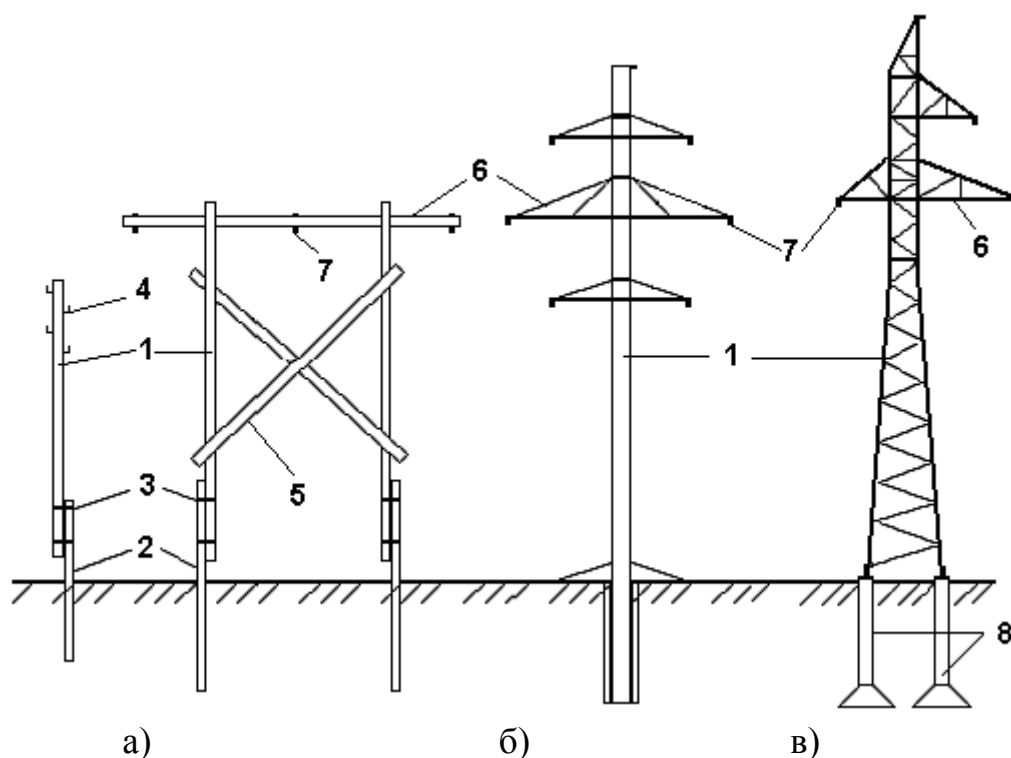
Деревянные (а), железобетонная (б) и стальная (в) опоры ВЛ: 1 – стойка опоры; 2 – железобетонная приставка (пасынок); 3 – бандаж из стальной проволоки или стальной хомут; 4 – крючья для армировки изоляторов; 5 – раскосы для жесткости; 6 - траверсы; 7 - сцепная арматура для крепления гирлянды изоляторов; 8 – железобетонные фундаменты.
